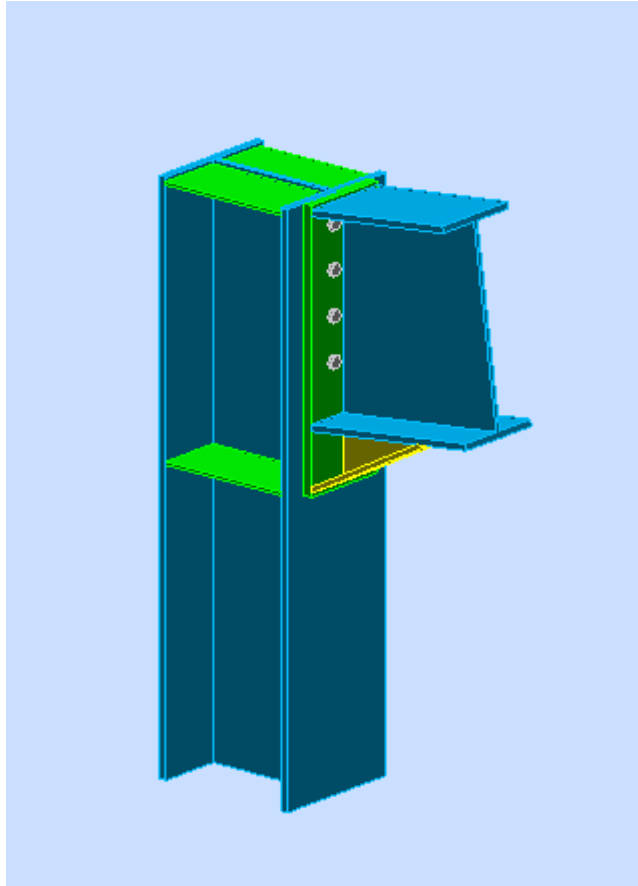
Vue 3D de l'assemblage poteau traverse.
